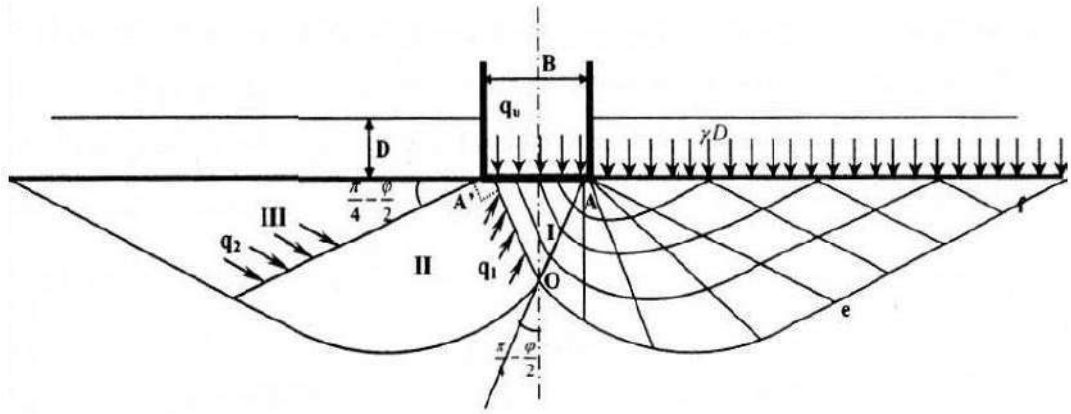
Mécanisme de rupture d'une fondation de base lisse (Prandtl (1920))
